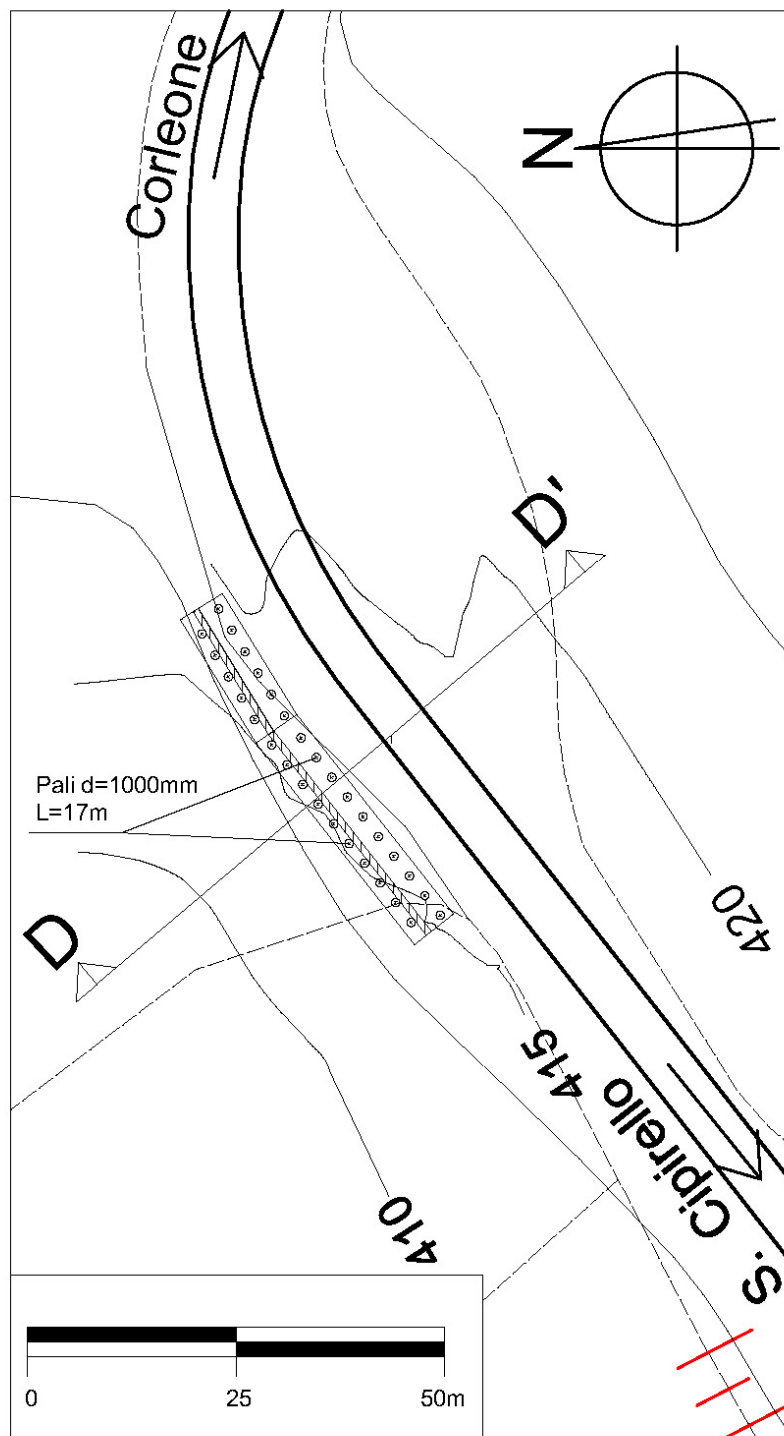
Dissesto al km 9+800. Planimetria schematica degli interventi da realizzare.
